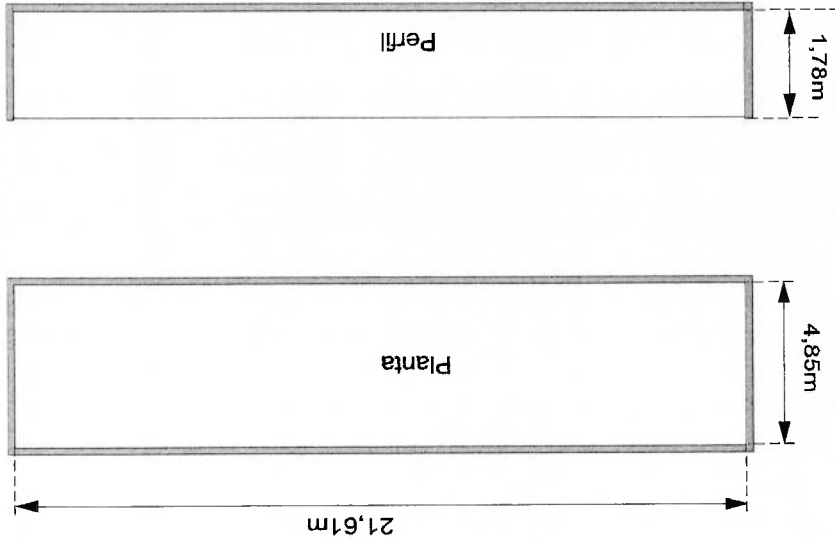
Desenho esquemático do tanque mostrando as dimensões principais
